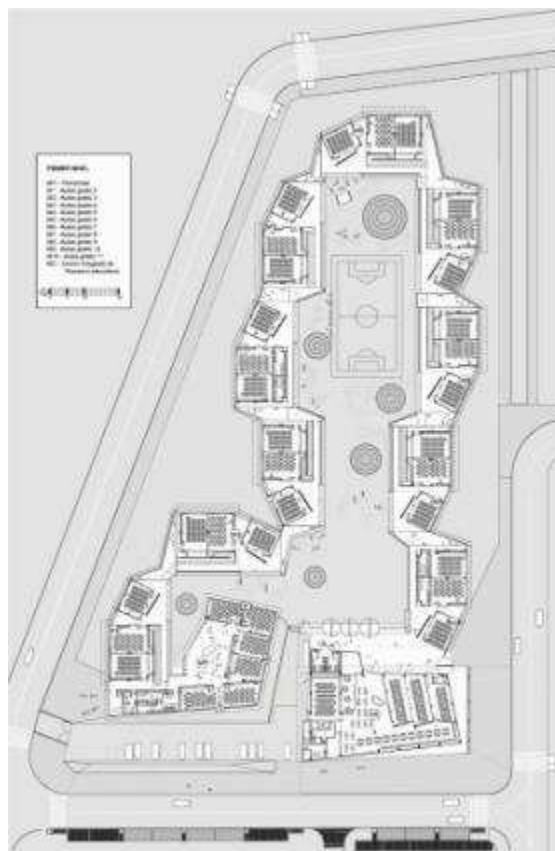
Planta baixa do térreo (PLATAFORMA ARQUITETURA, 2011)
